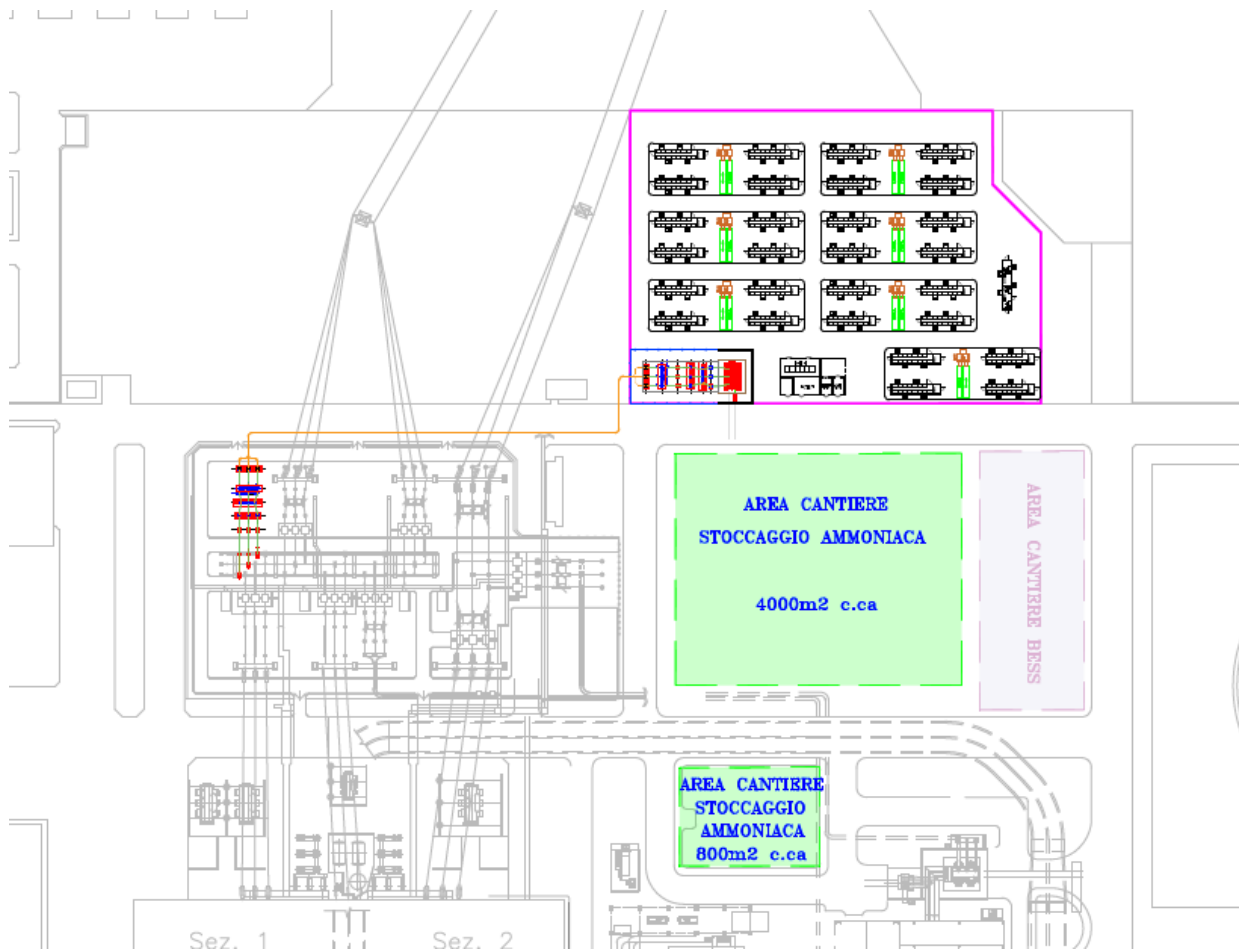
Stralcio della planimetria generale dell'area BESS
